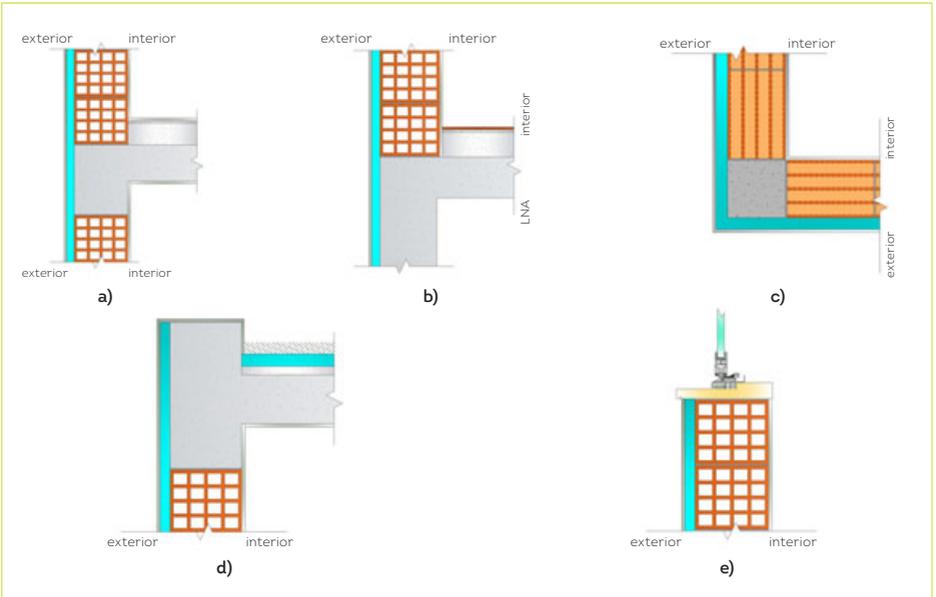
Tipos de pontes térmicas lineares: a) Ligação entre fachada e pavimento intermédio; b) Ligação entre fachada e pavimento sobre local não aquecido; c) Ligação entre duas paredes; d) Ligação entre fachada e cobertura; e) Ligação entre fachada e caixilharia.
